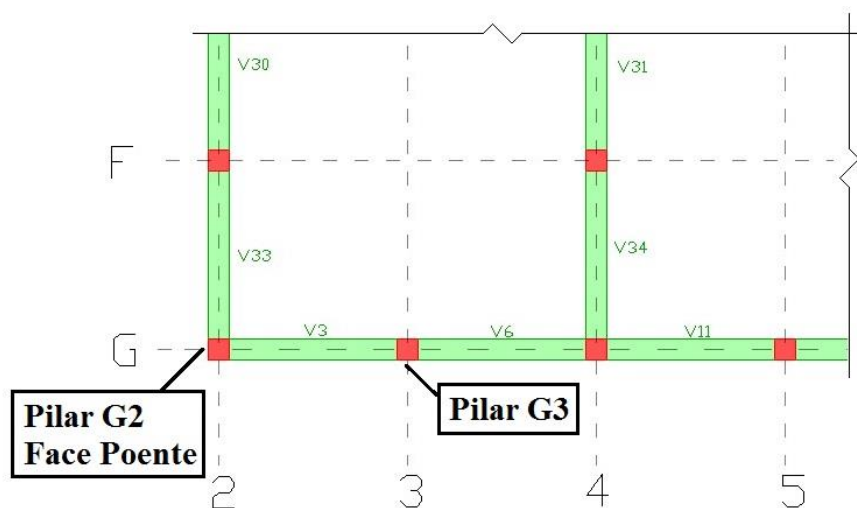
Localização de ensaio de detecção de armaduras.
